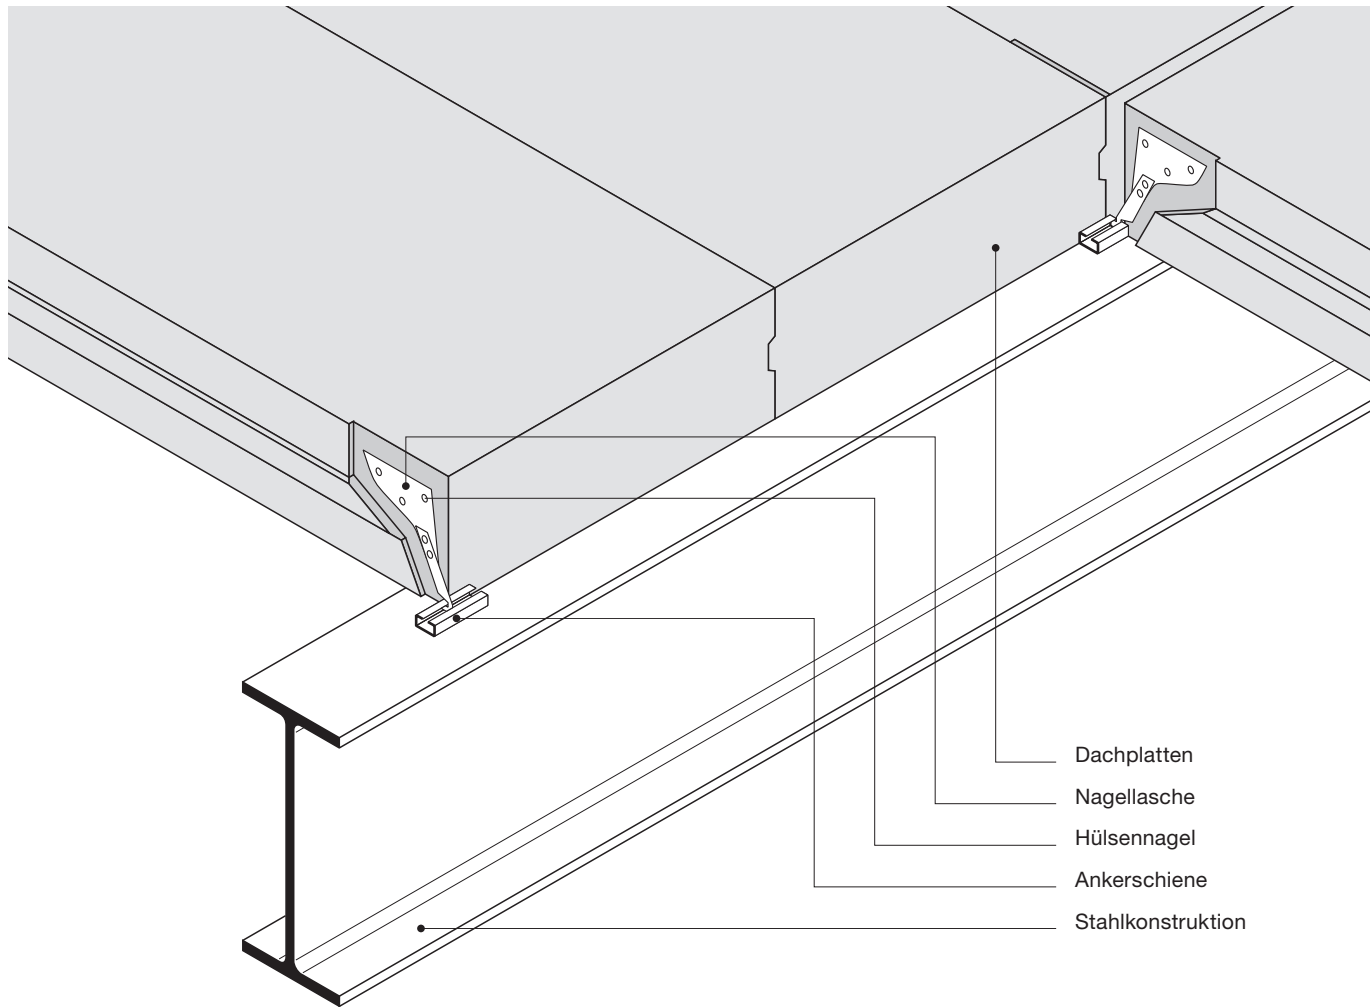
Beispiel für eine Auflagerung von Deckenplatten aus bewehrtem Porenbeton: Verankerung auf einem Stahlträger mit Ankerschienen und Nagellaschen
